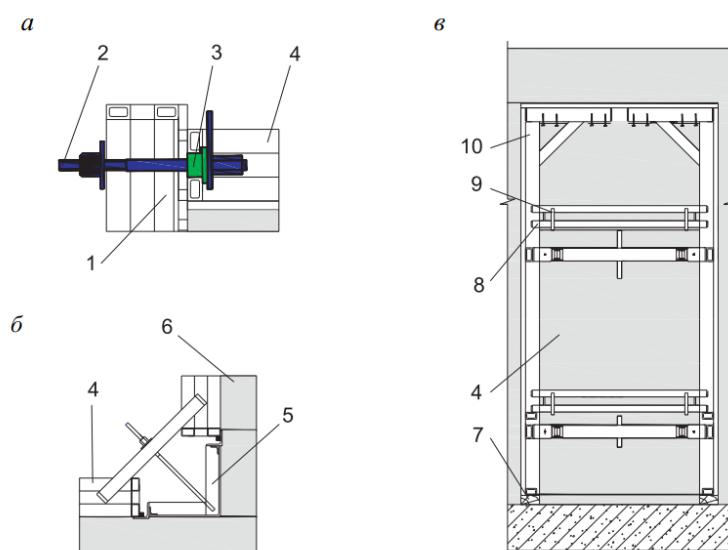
Схеми установки елементів опалубки шахти ліфта: а – вузол стикування зовнішніх панелей; б – установка внутрішнього рознімного кута; в – установка дверного отвіроутворювача; 1 – перфорований щит; 2 – замок; 3 – сухар; 4 – щит опалубки; 5 – внутрішній роз'ємний кут; 6 – стіна; 7 – дерев'яна підкладка; 8 – балка кріплення отвіроутворювача; 9 – гвинт
